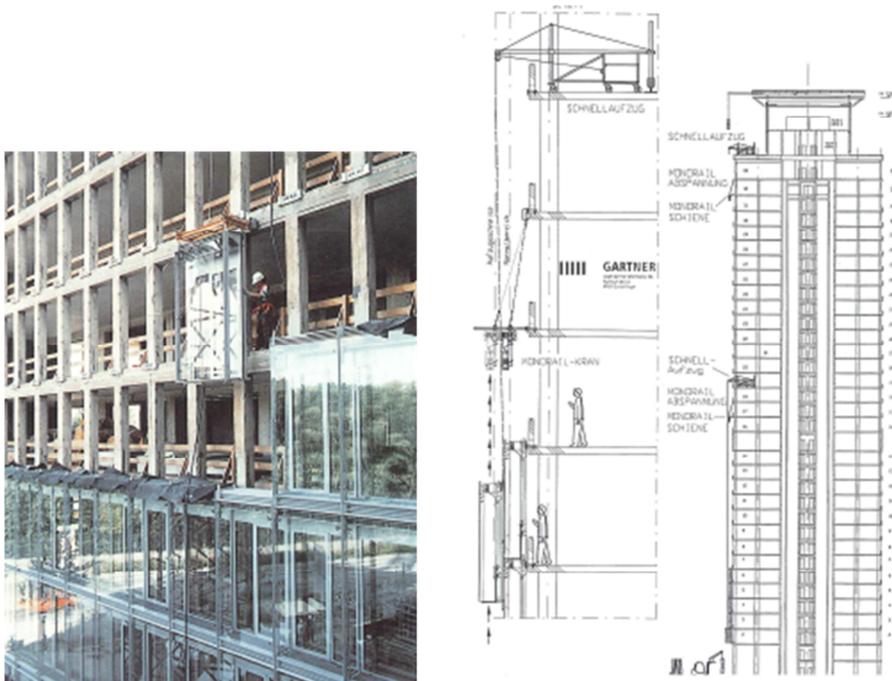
Montage von Fassadenelementen mit einer Schienenanlage am Beispiel Business Tower, Nürnberg<sup>183</sup>
